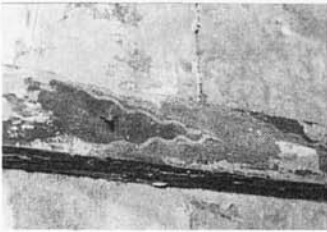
Traviesa (Sant Pere i Sant Bernat 3)
